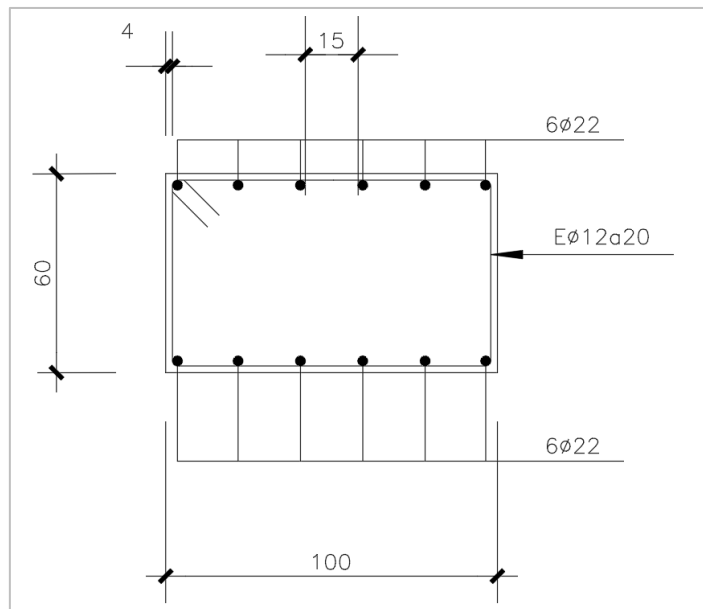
Detallamiento corte A-A zapata, ESC: 1:50
